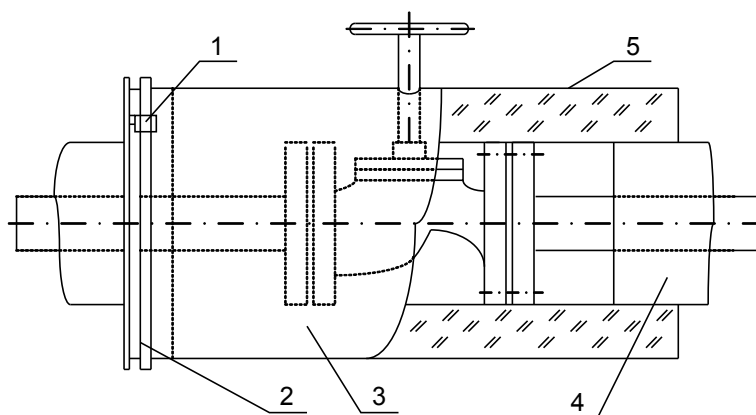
Тепловая изоляция арматуры фланцевой теплоизоляционными цилиндрами:
